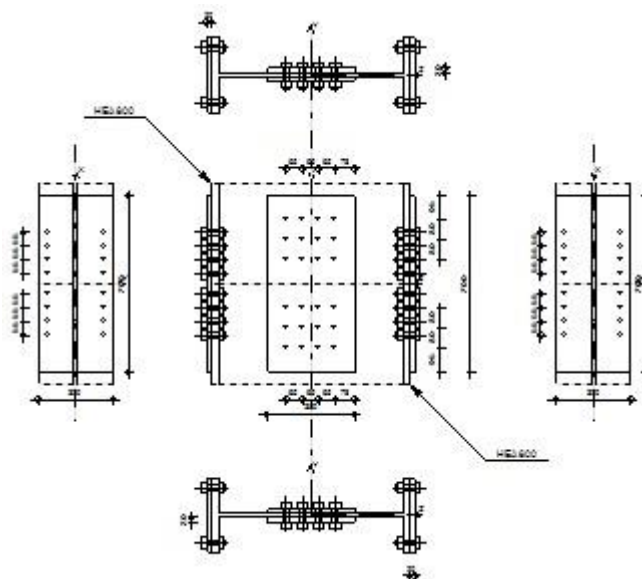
Vérification de l'assemblage poteau-poteau
